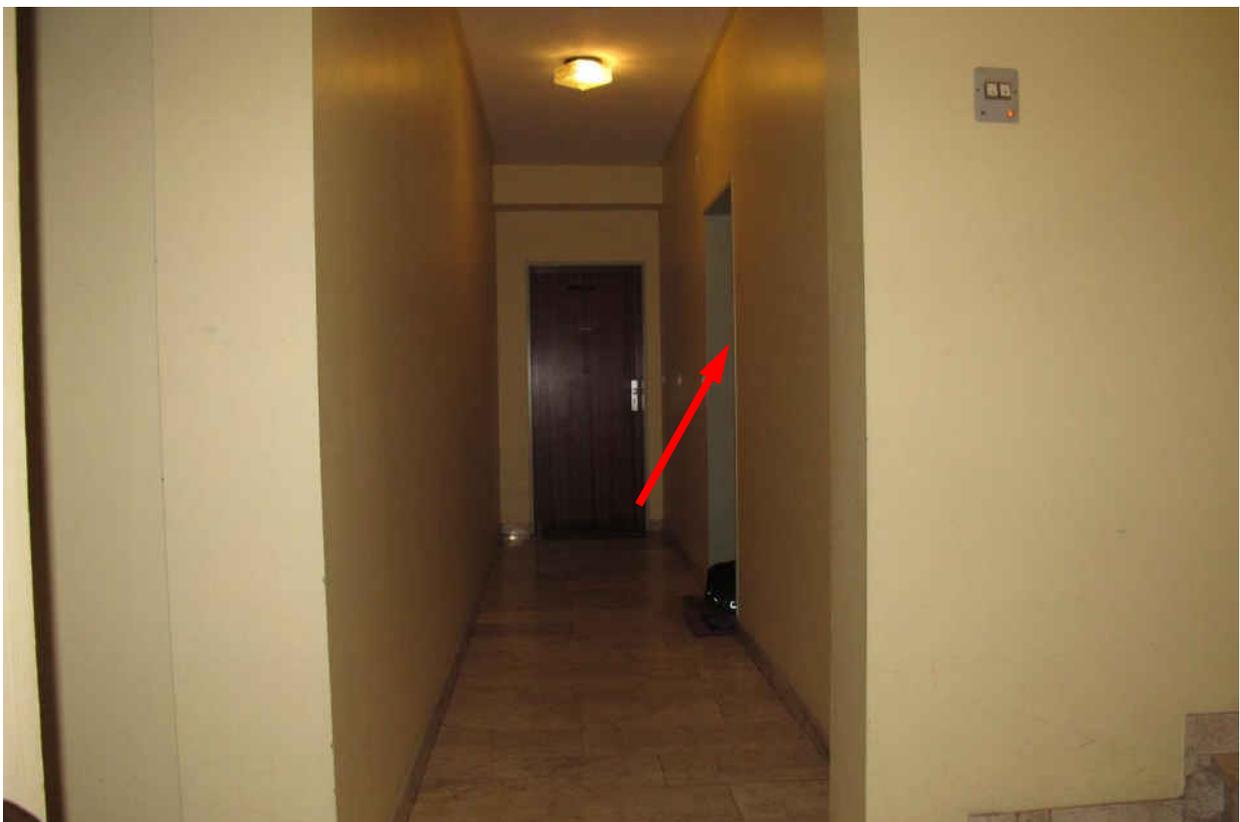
Flur mit Wohnungszugang (siehe Pfeil)
